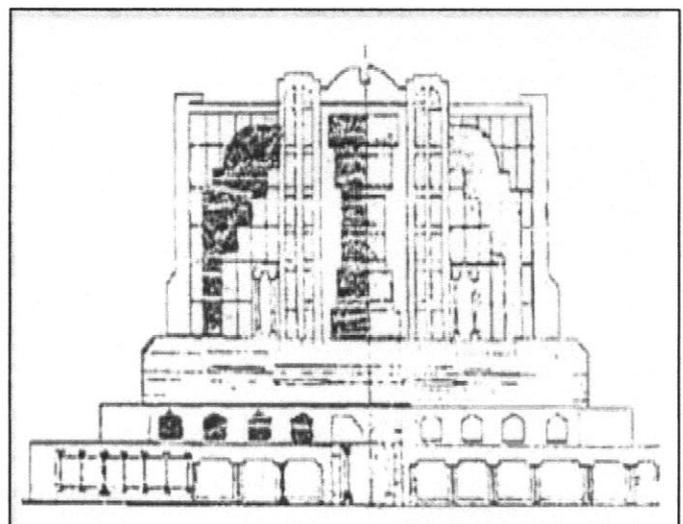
Façade du centre multifonctionnel de Sidi Brahim.
